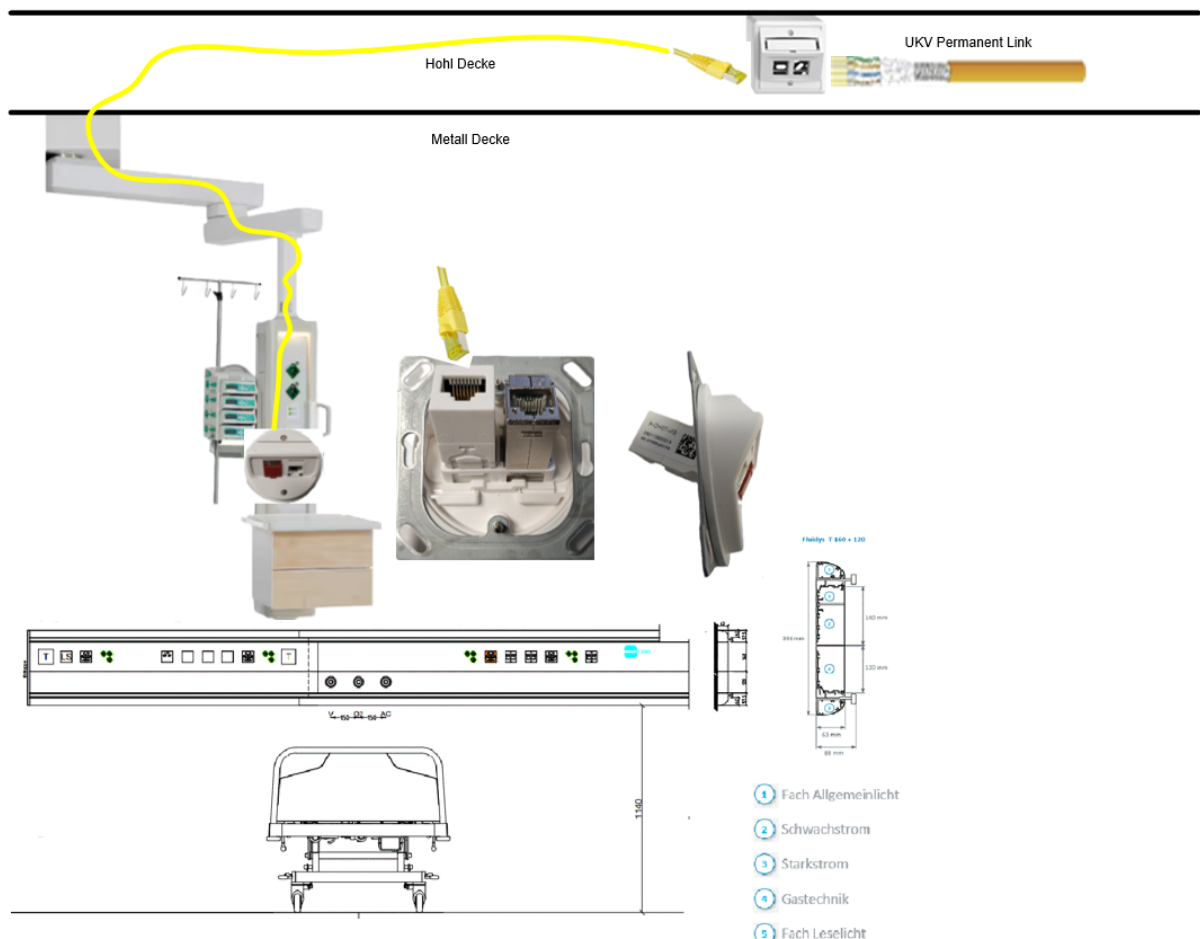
Flexible Installationen mit beweglichen Komponenten (z. B. beweglicher Arm)
